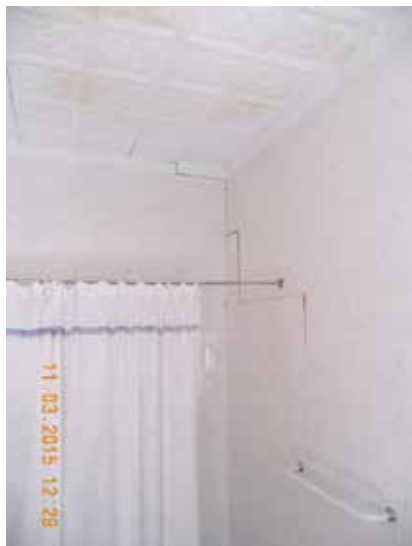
Testigo de la viga de la primera crujía no fisurado.
